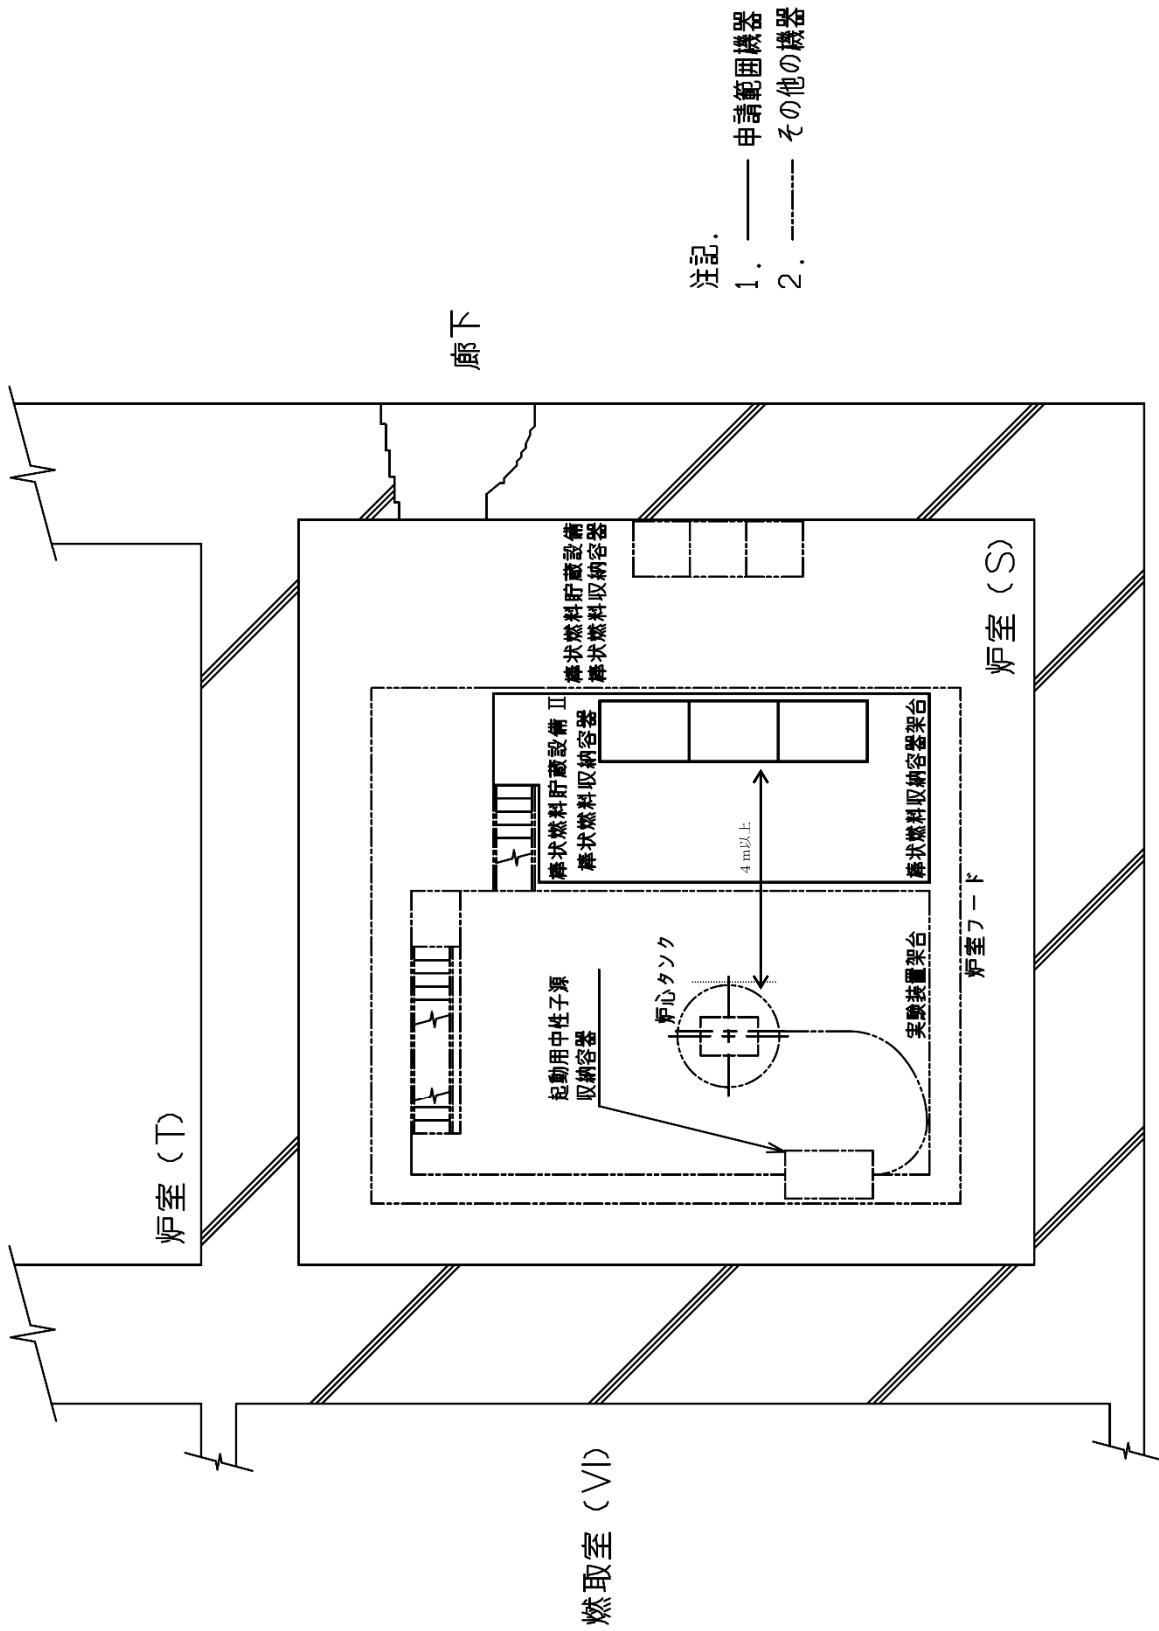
棒状燃料収納容器、架台配置図(平面図)
